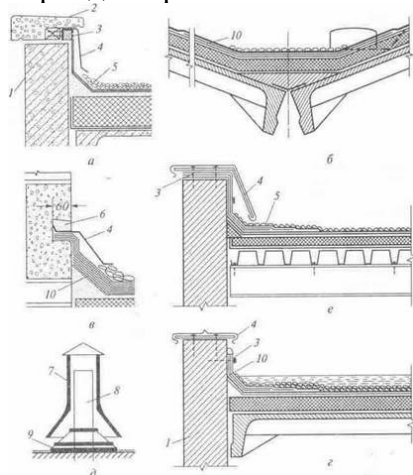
Варианты примыканий рулонных и мастичных кровель: а — к парапету с карнизной плитой; б — к ендове; в — к вертикальной стене; г — к парапету без карнизной плиты; д, е — при мастичной и водонаполненной кровлях; 1 — парапет; 2 — карнизная плита; 3 — крепление рулонных слоев; 4 — металлический фартук; 5 — защитный слой; 6 — растворная заделка; 7 — пластмассовый колпак; 8 — вытяжная труба; 9 — резиновый фланец; 10 — дополнительные рулонные слои
